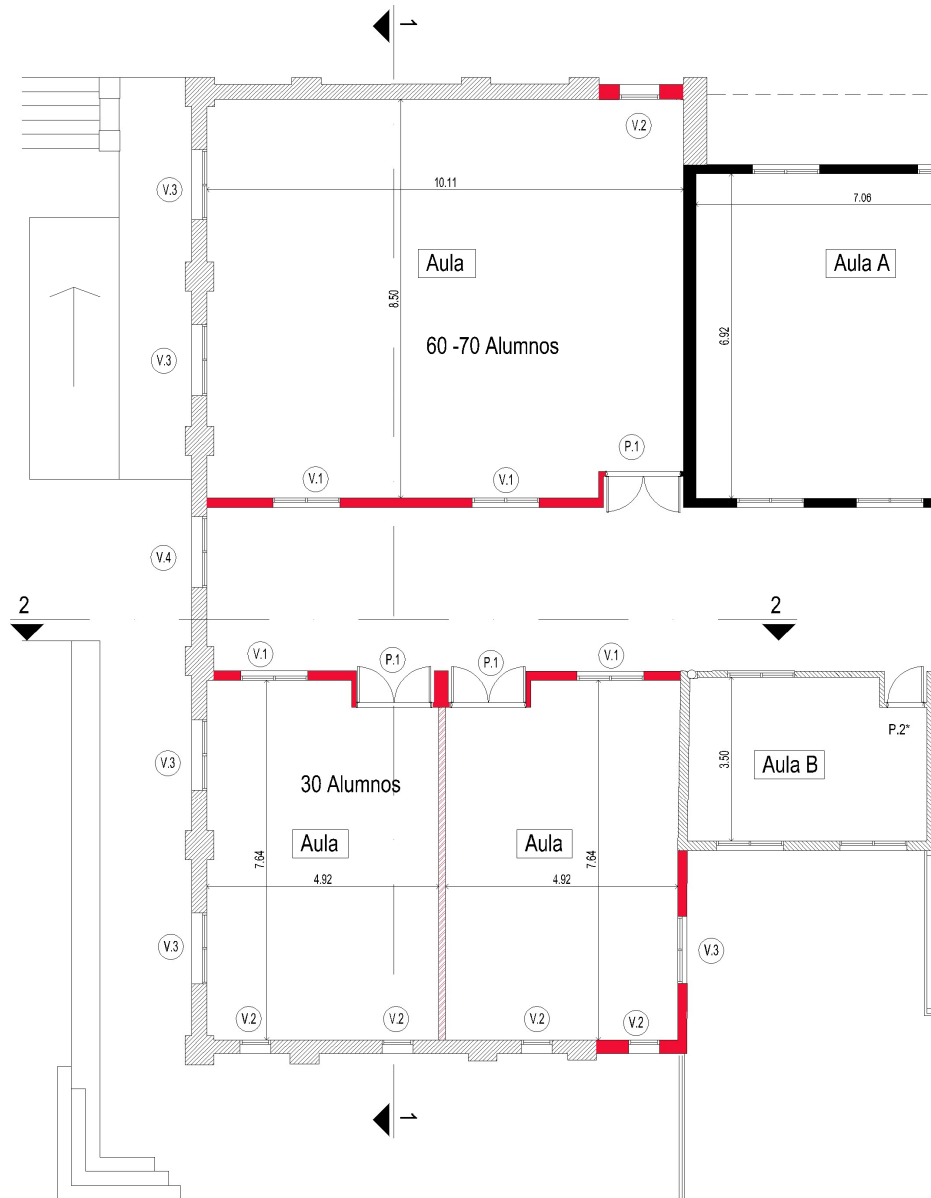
Plano Planta de Primer Piso. Aulas y pasillo de vinculación.
